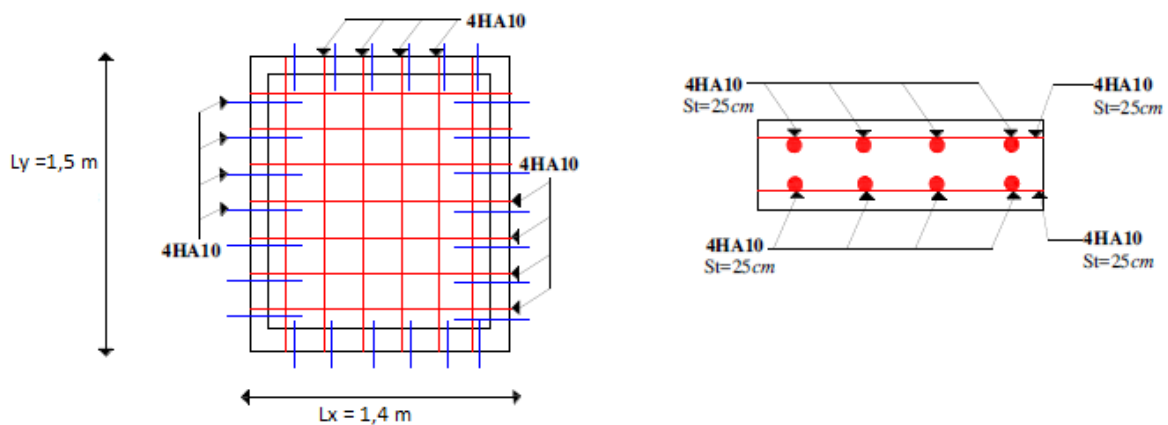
Schéma de ferrailage de la dalle d'ascenseur
